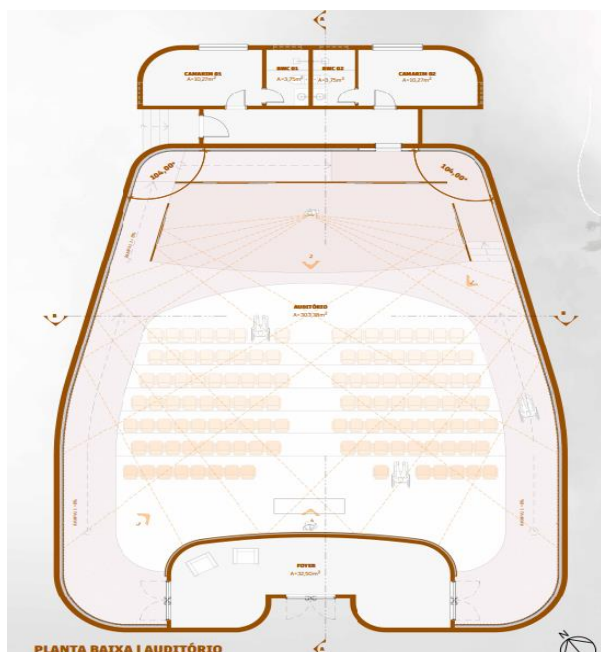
Planta Baixa do Auditório, apresentando o layout e reflexões (Autores, 2023)
